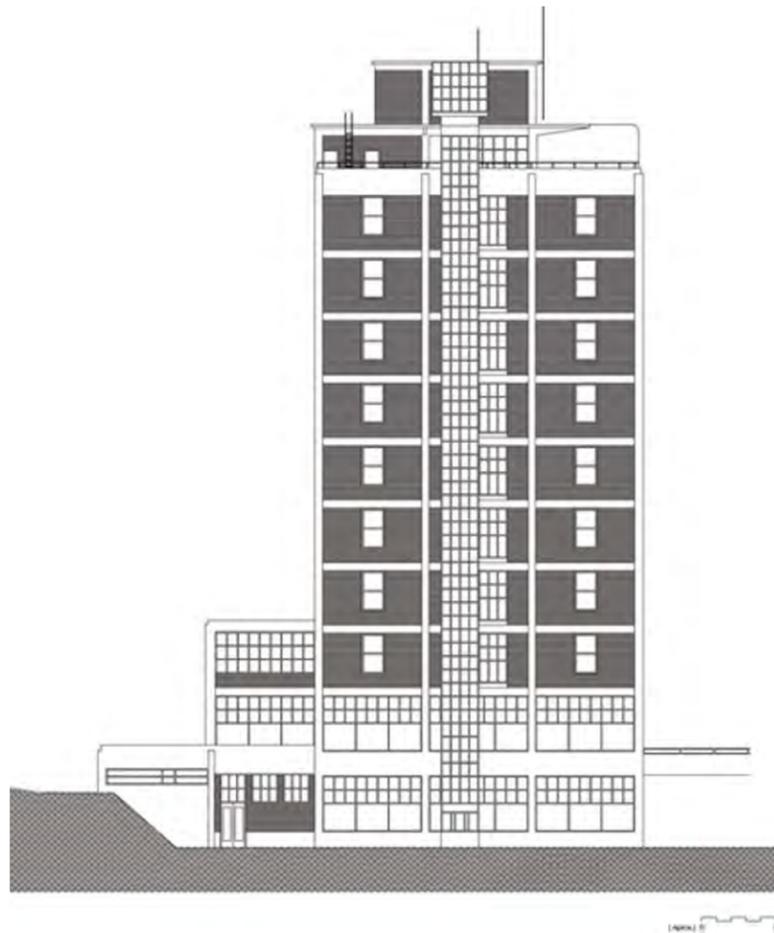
Alzado lateral del Hotel. Se aprecia su adaptación a la pendiente del terreno y la elegante proporción vertical obtenida a partir del módulo estructural visto.
